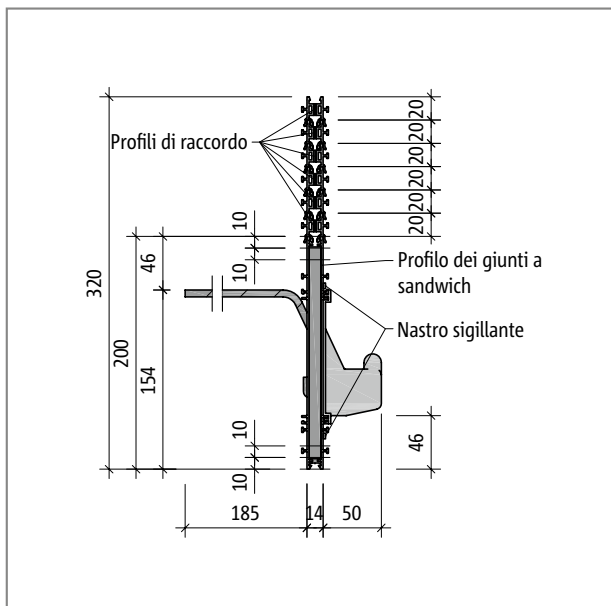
Schöck Tronsole® tipo T, sezione dell'elemento con profilo dei giunti a sandwich e profili di raccordo
